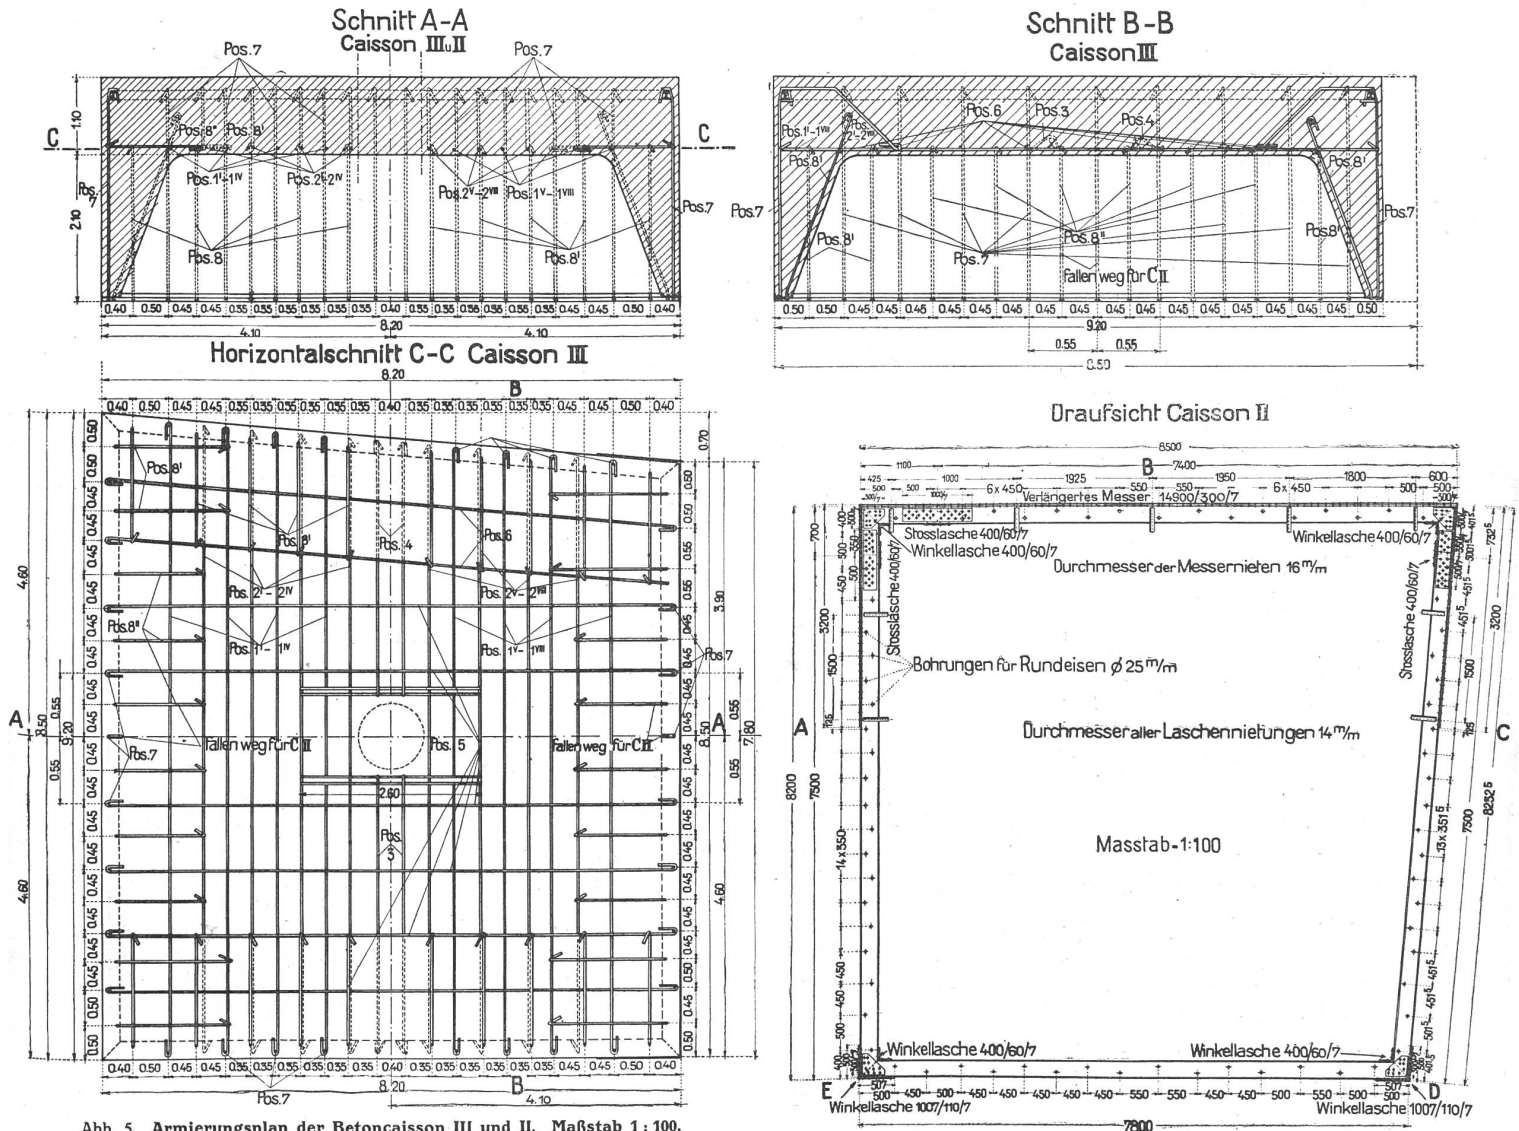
Armierungsplan der Betoncaisson III und II. Maßstab 1:100.
